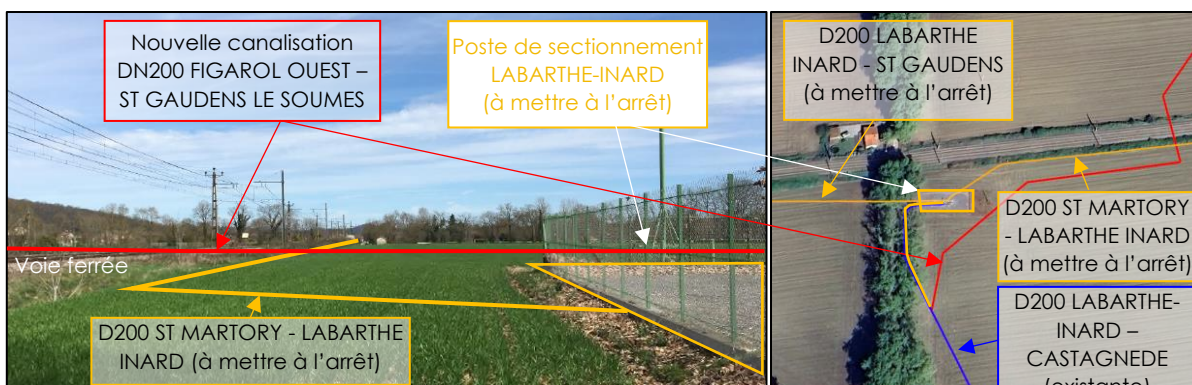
Traversée de la voie ferrée à Labarthe-Inard et poste de sectionnement de Labarthe-Inard
